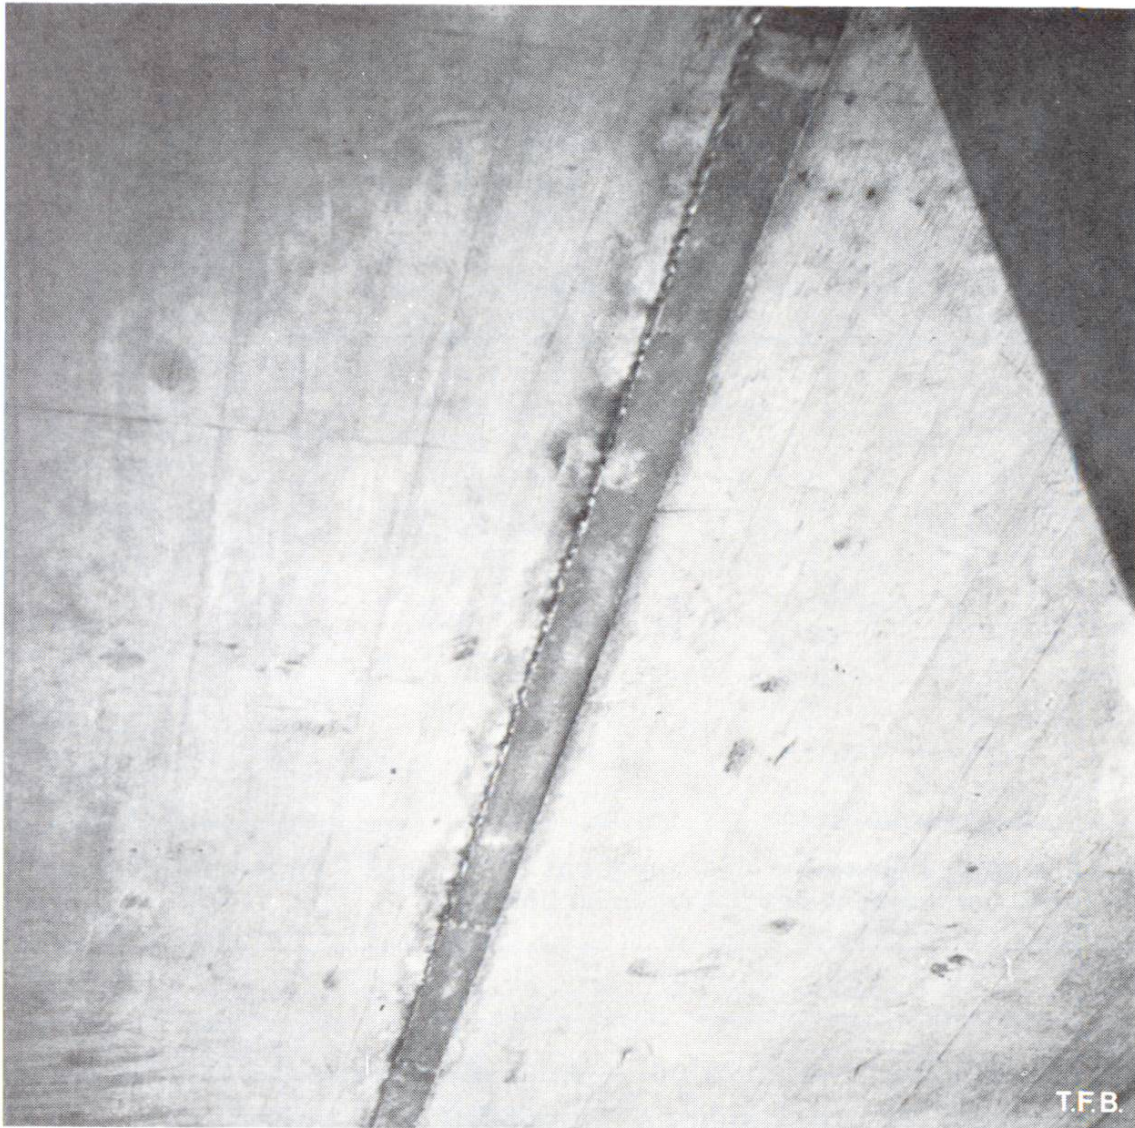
Joint non étanche entre un panneau de coffrage et la planche de remplissage. Formation d'une grosse bavure.
